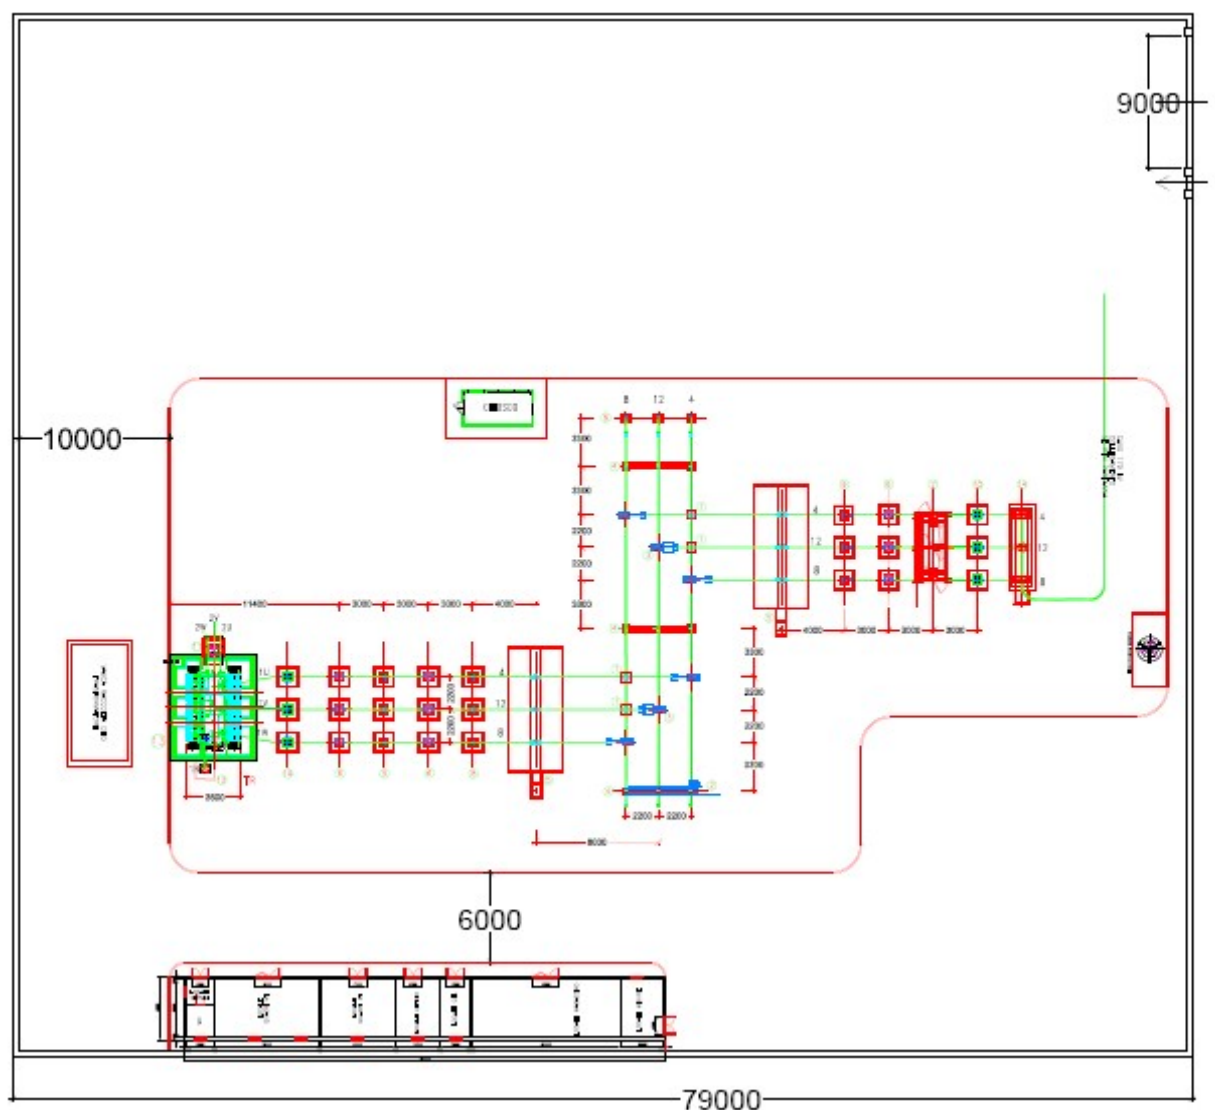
planimetria elettromeccanica stazione elettrica di trasformazione
